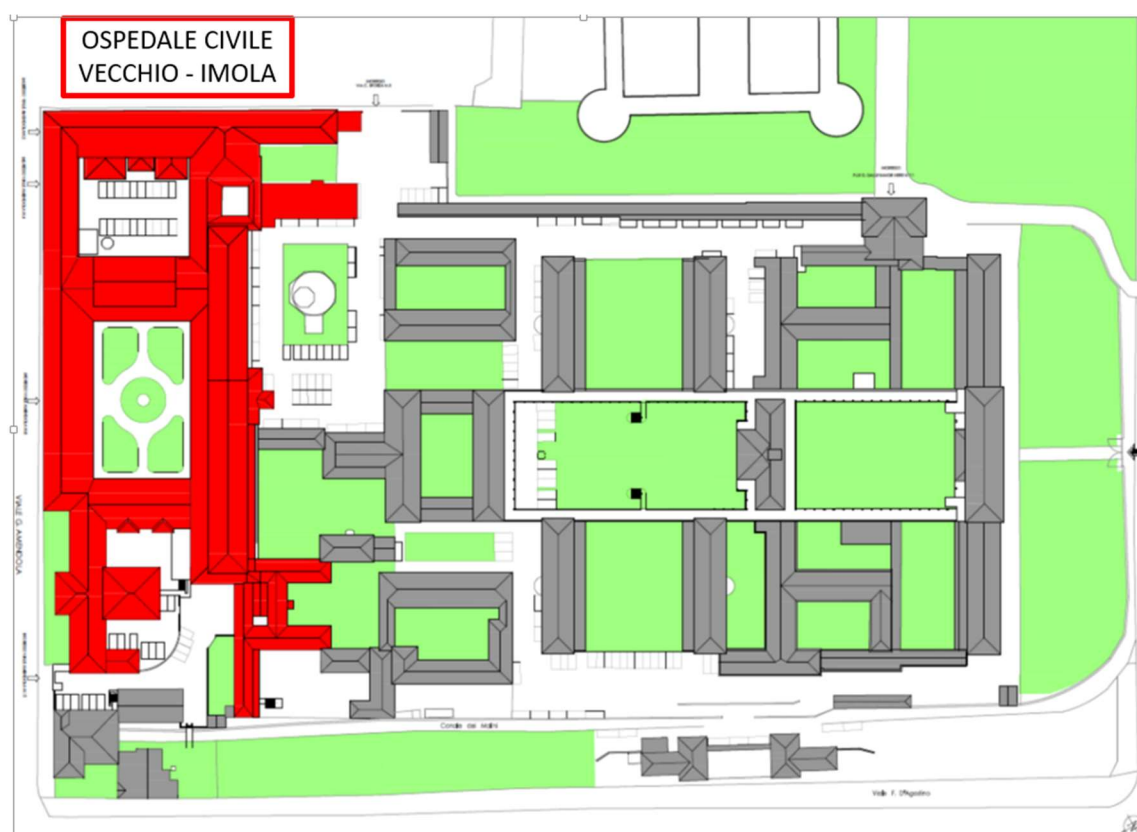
planimetria generale del complesso Ospedale Civile Vecchio – L. Lolli di Imola
